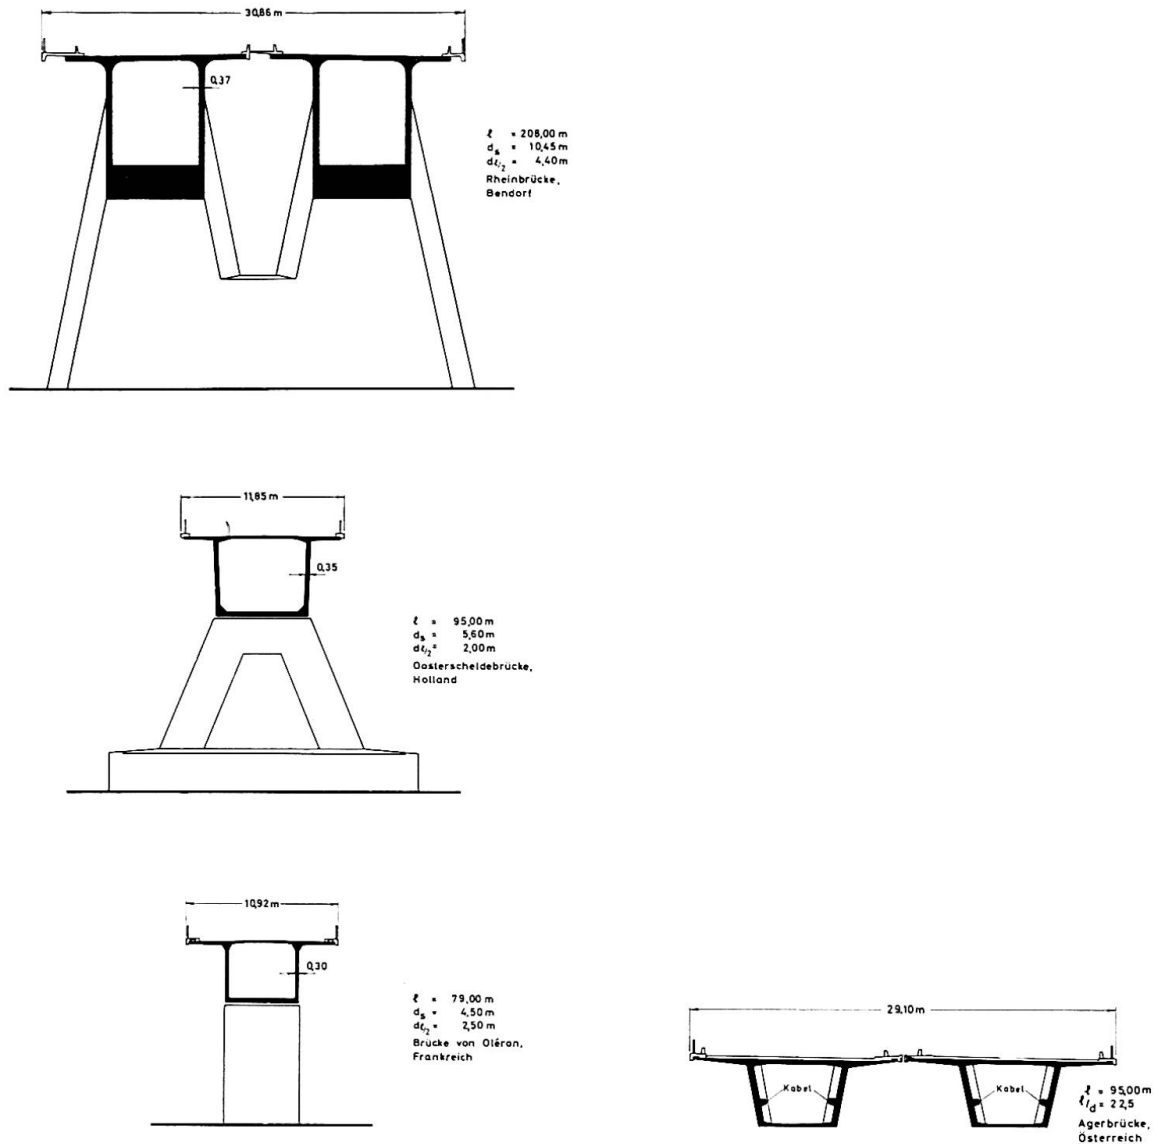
Querschnitte einiger besonders weitgespannter Brücken mit Hohlkästen.
